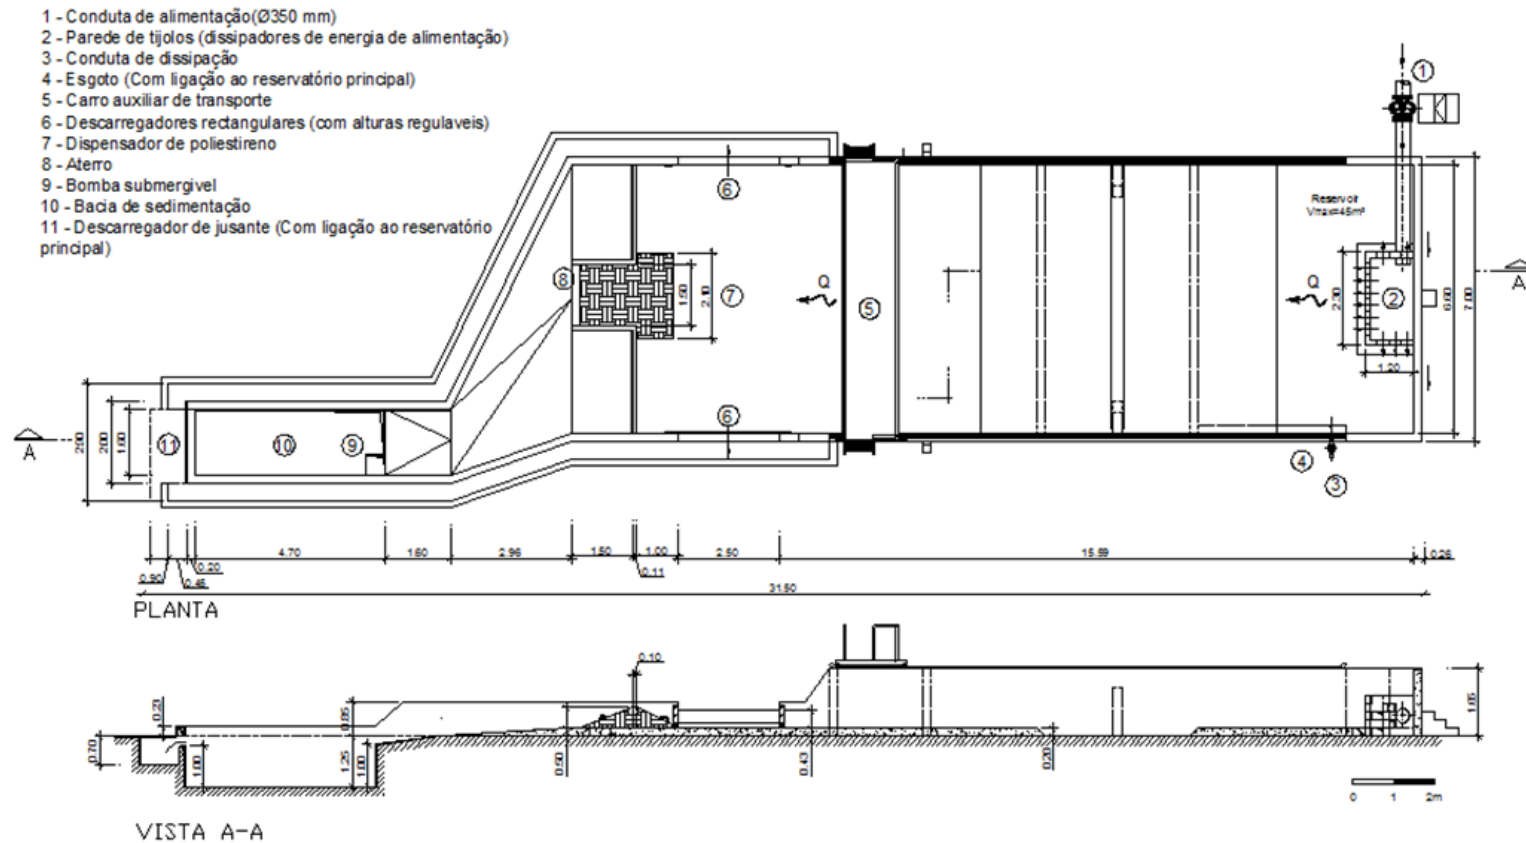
Esquemas em planta e vista lateral (A-A) da estrutura do canal de ensaio (AutoCAD).
